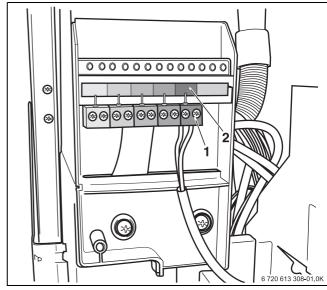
Stecker für Warmwasser-Temperaturfühler (Speicher) aufstecken
